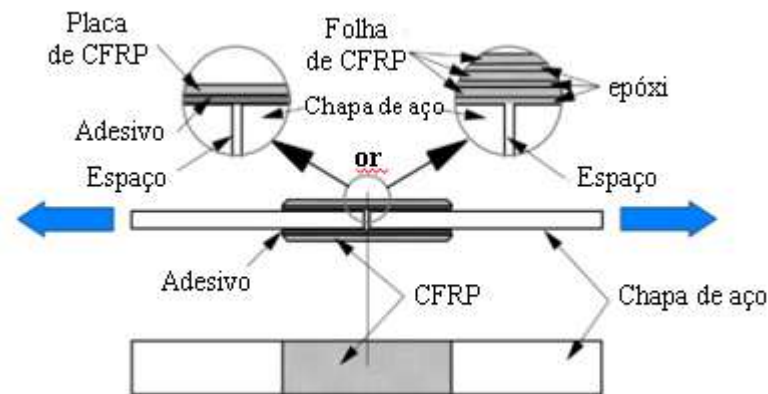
Tipo 3: carregamento aplicado diretamente à placa de aço, com folga
